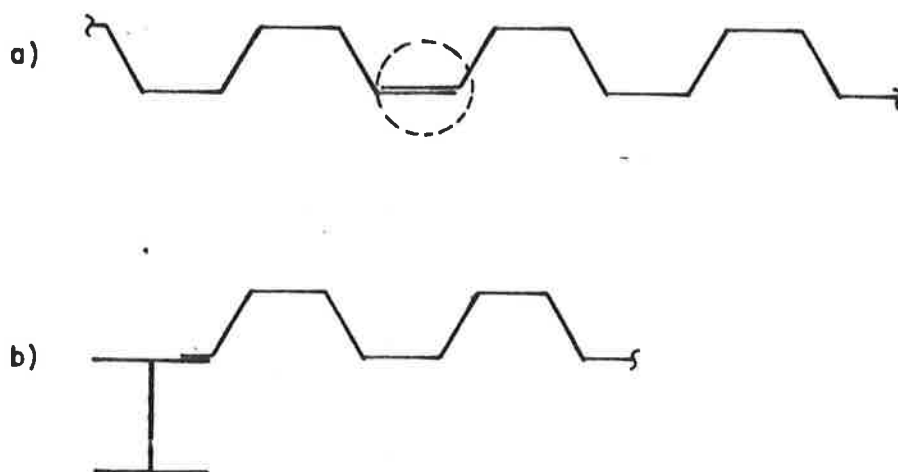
O aparecimento de frestas na execução da laje composta: a) ligação chapa-chapa; b) ligação chapa-viga de aço.
